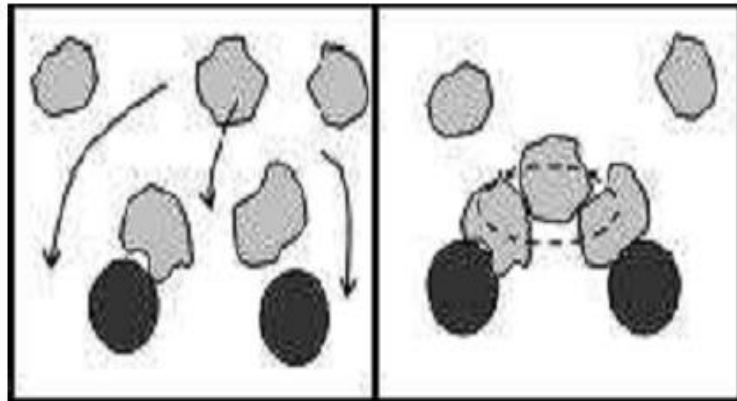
Représentation en plan d'un blocage de granulats à travers deux armatures.
